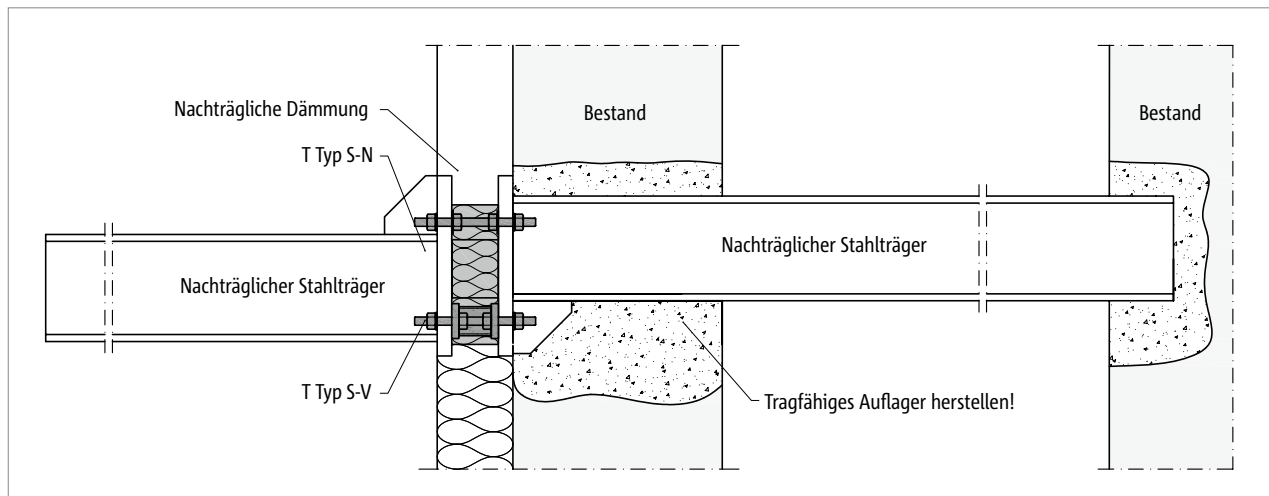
Schöck Isokorb® T Typ S-N und T Typ S-V: Nachträglicher Stahlbalkon frei auskragend; angeschlossen mit Höhenversatz an nachträglich eingebauten Stahlträger
